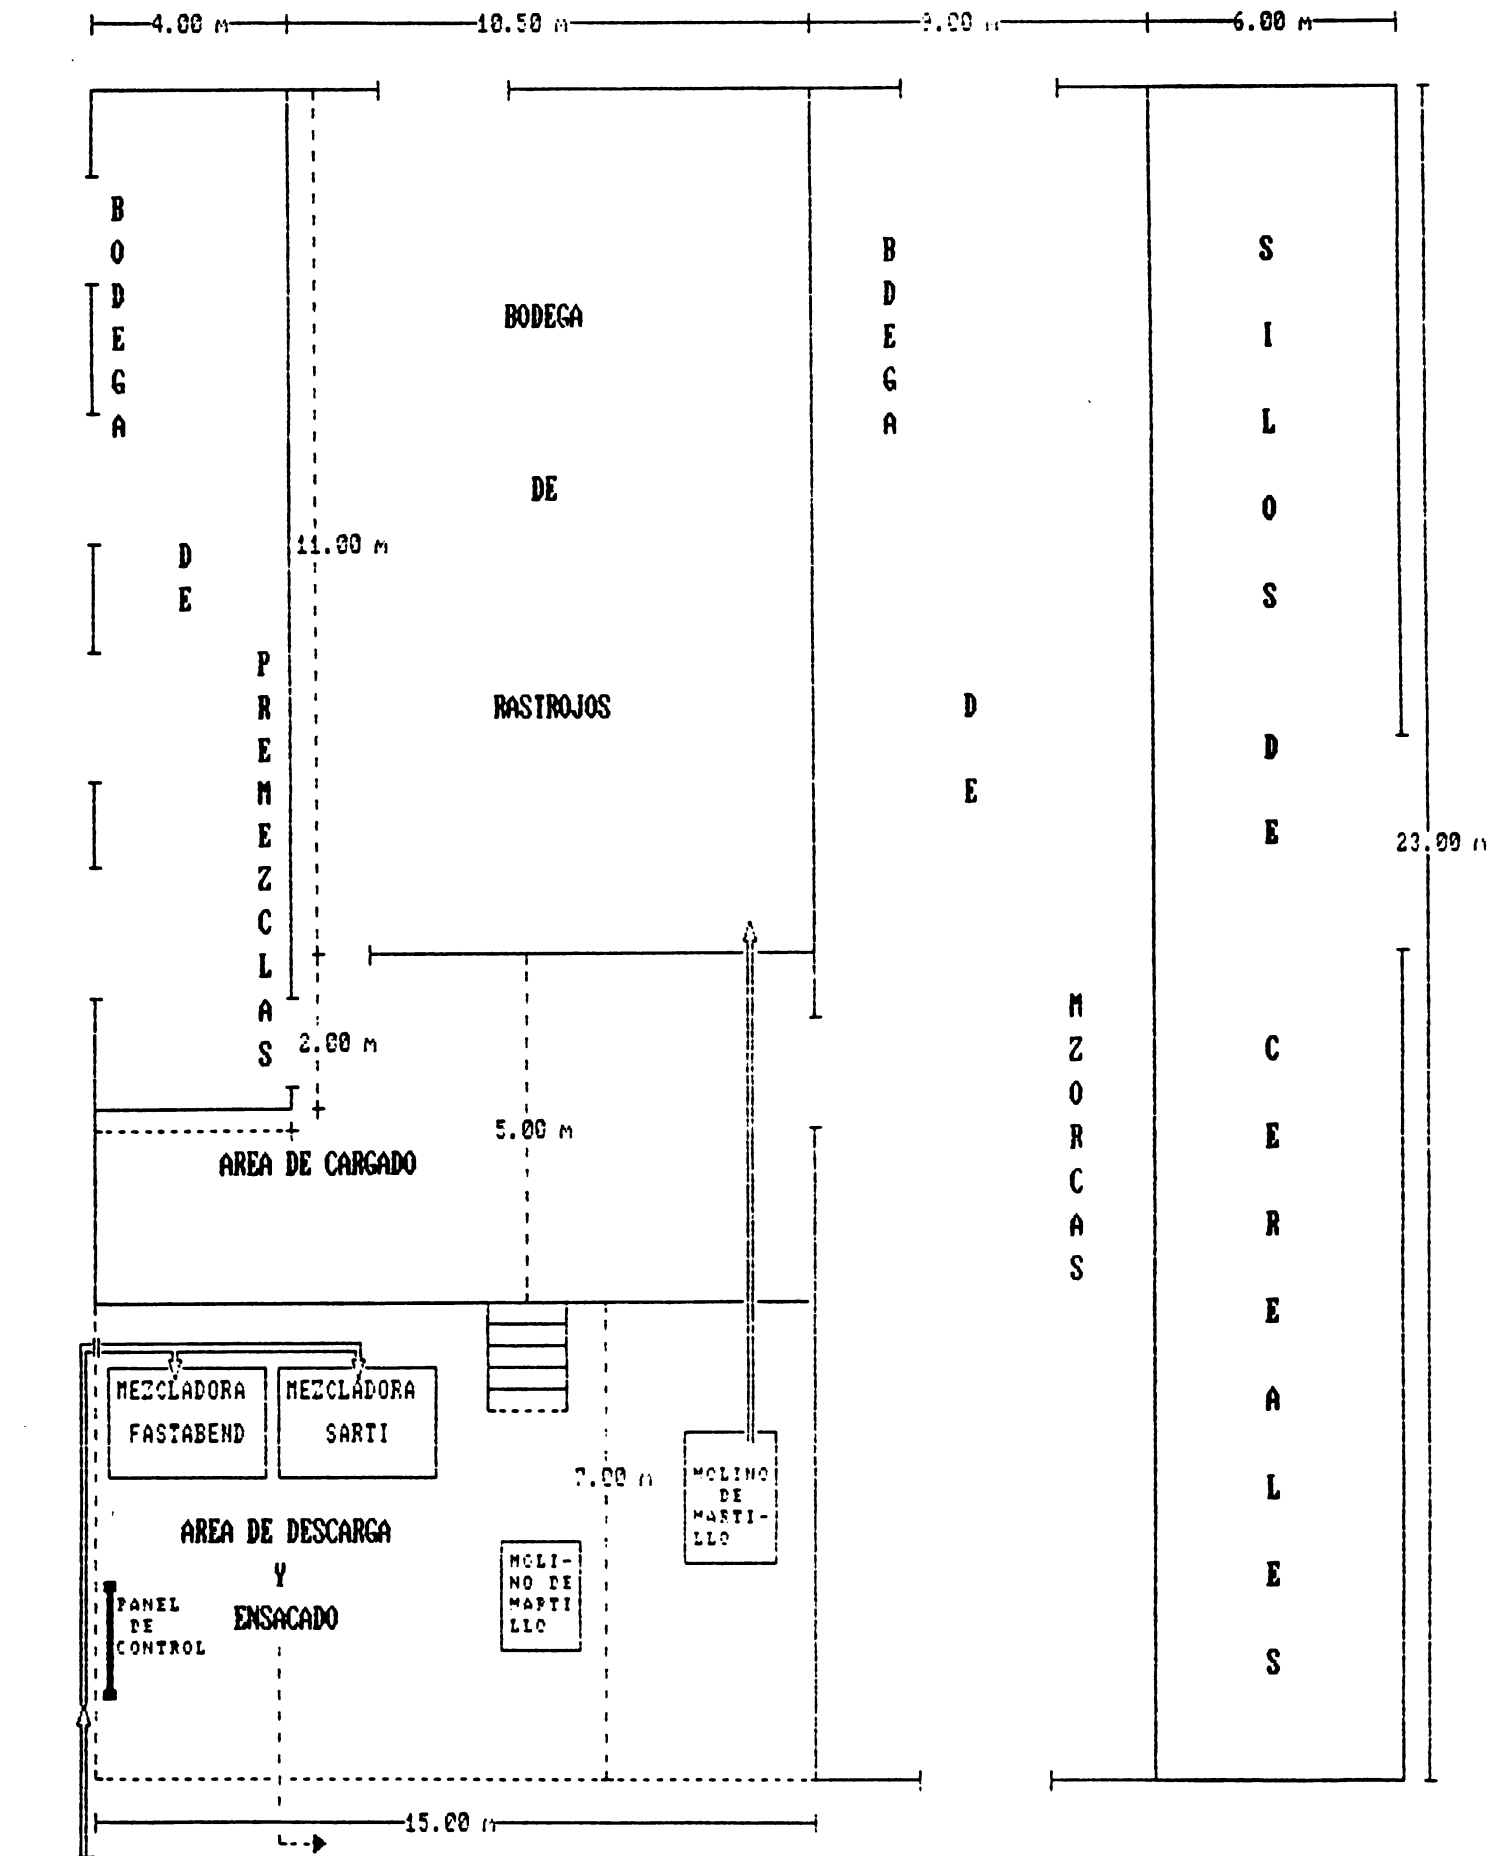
VISTA SUPERIOR DE LA PLANTA DE CONCENTRADOS Y BODEGAS
